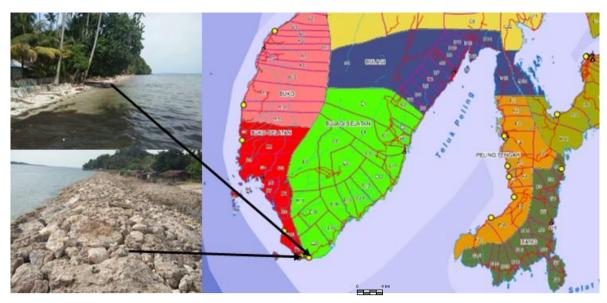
Fondasi Rumah Terabrasi di Salakan (foto kiri) dan Bangunan Penahan Ombak Berlapis, yaitu Tembok Dinding Laut dan Susunan Balok Konkrit di Ambelang
